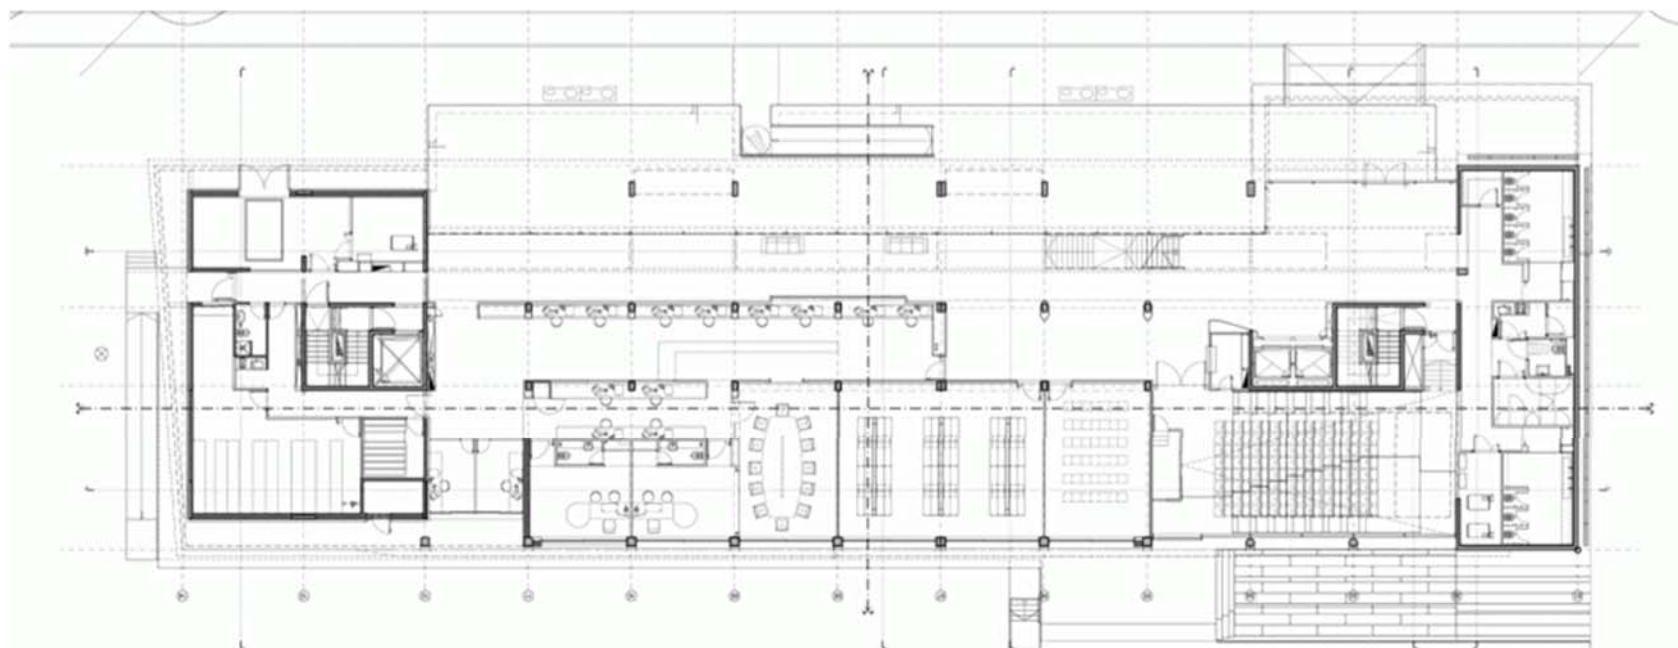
Planta Base, obtenida de <http://www.archdaily.com/?p=470303>
